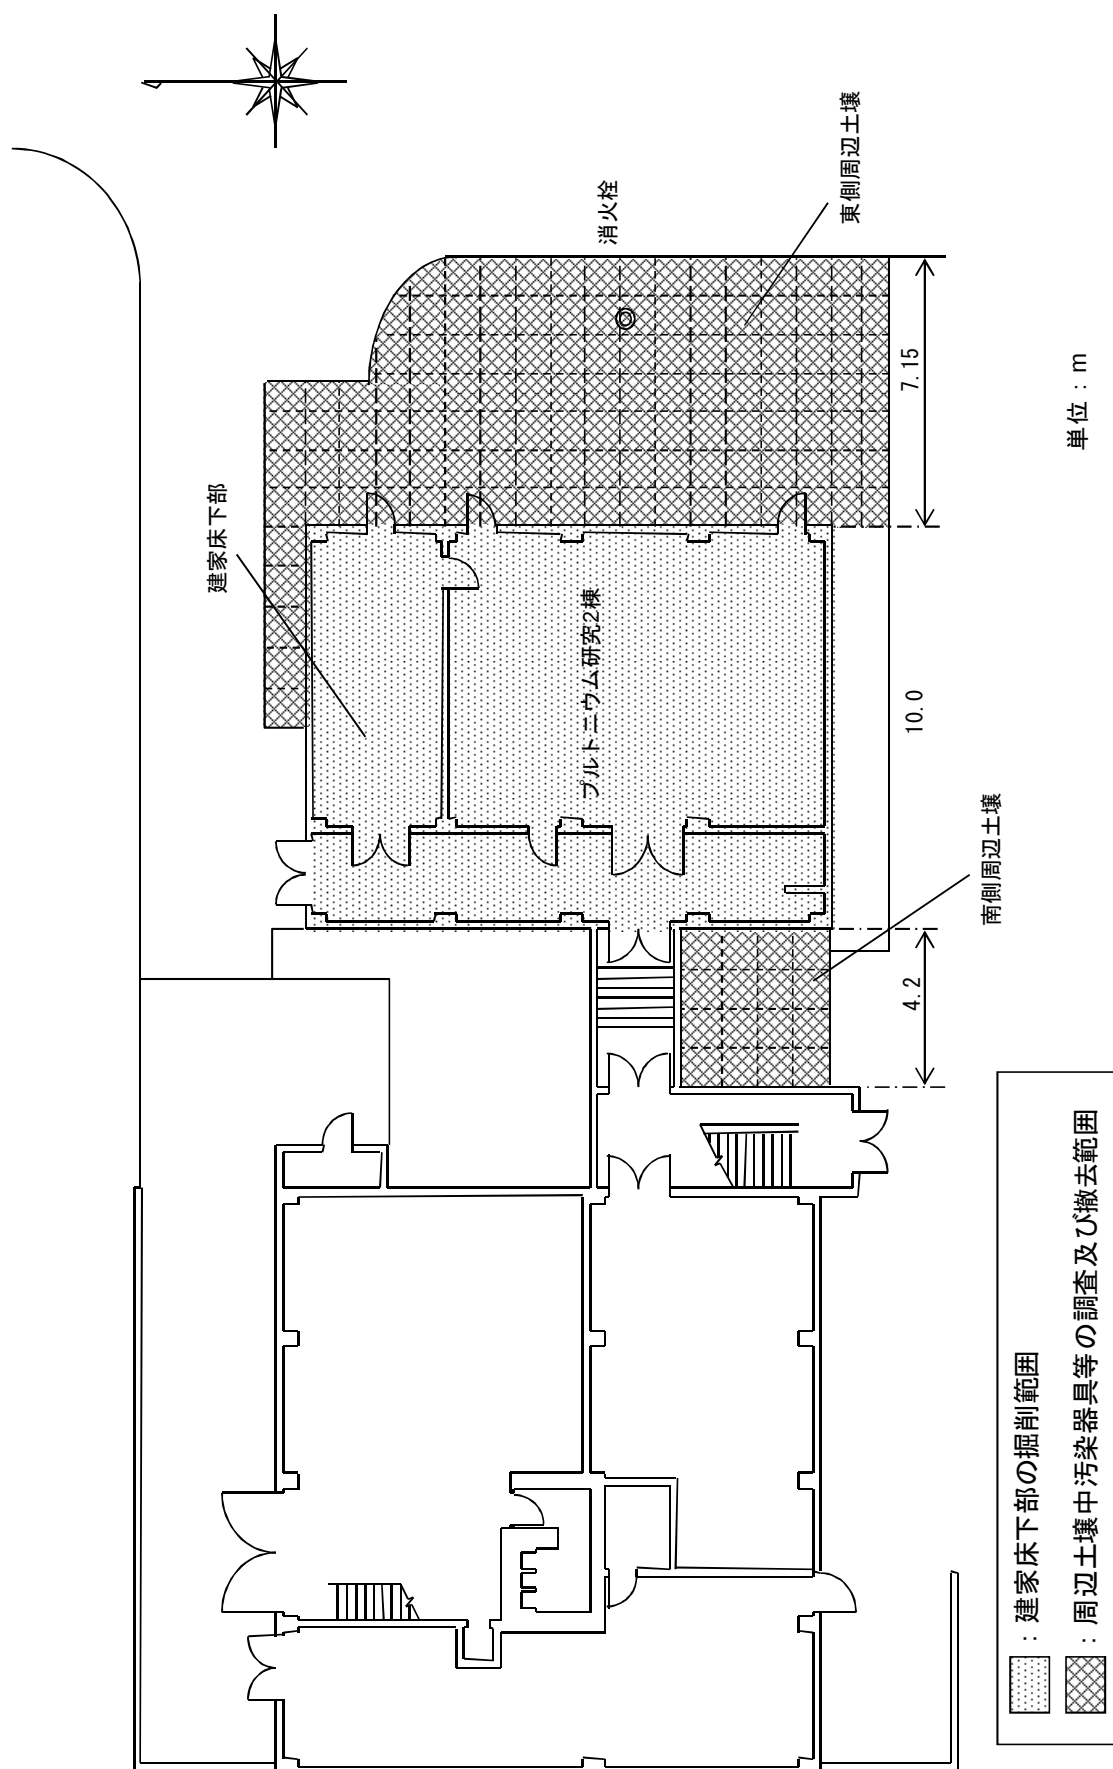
作業範囲の平面図 (プルトリウム研究2棟)
